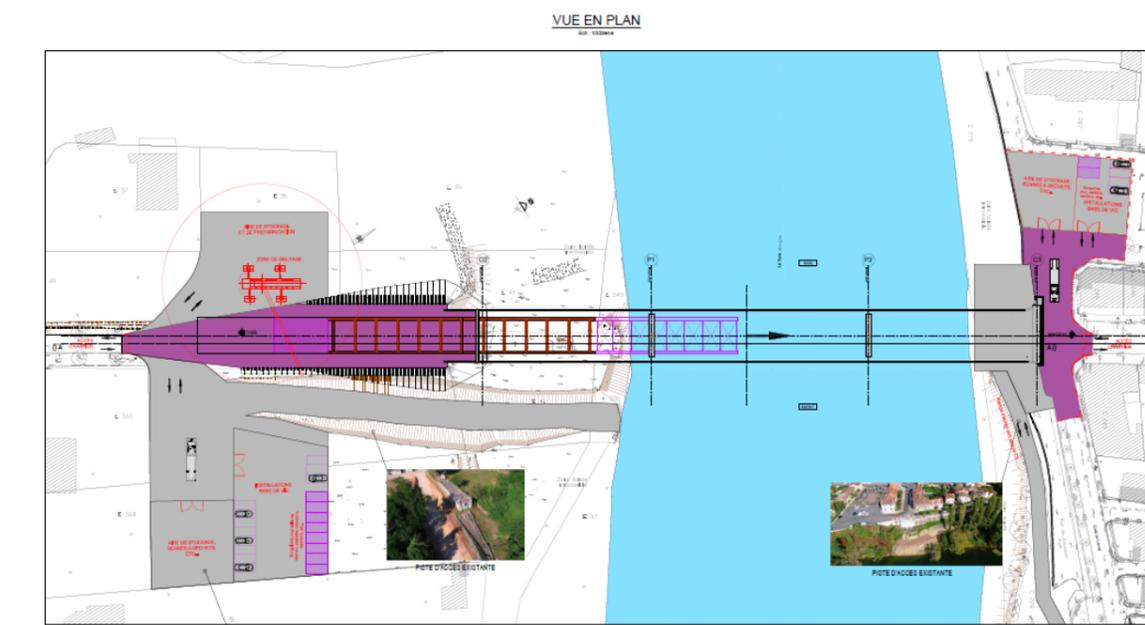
Plan des emprises du projet (source : AVP Ingérop)
